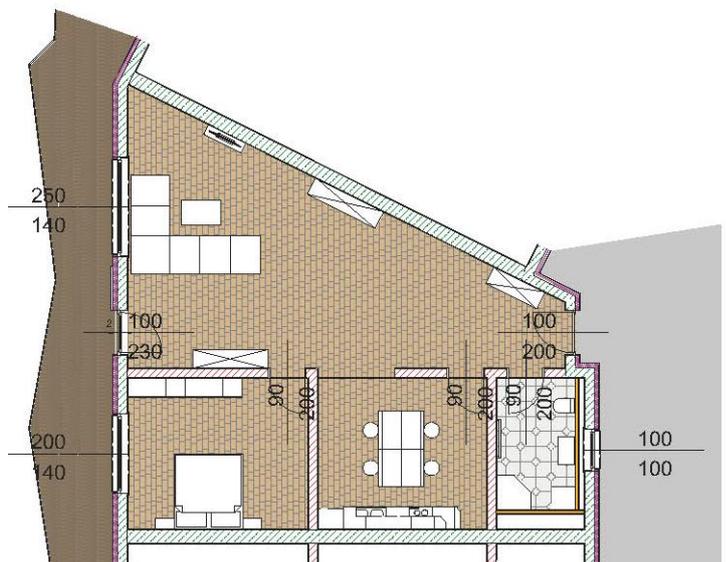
| Grundrisse Wohnungen Maßstab 1:200
